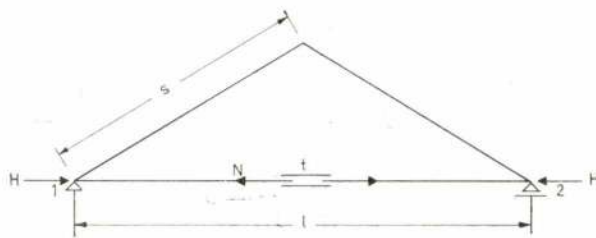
Acção de um pré-esforço no tirante aplicado por um tensor t
